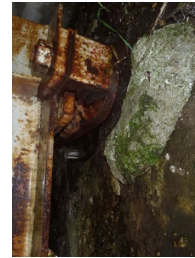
(1) 支承アンカー位置からのひび割れ
